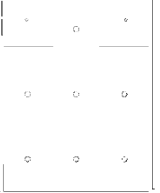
Denah Ruang Rawat Inap Kelas 3
